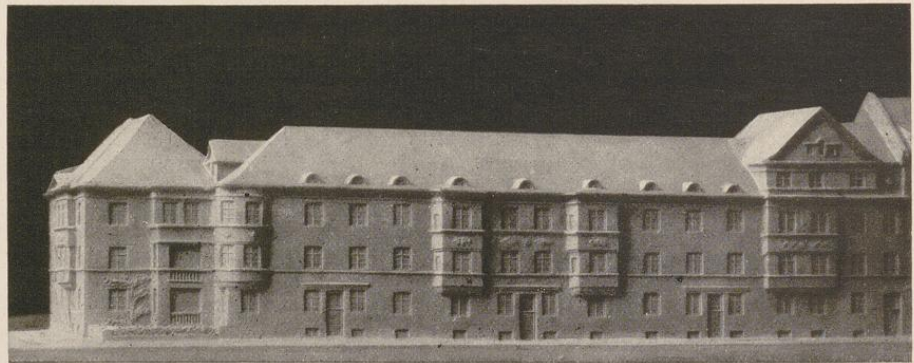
Modell zu obigen Grundrissen. Ansicht nach der Schlosserstraße.
